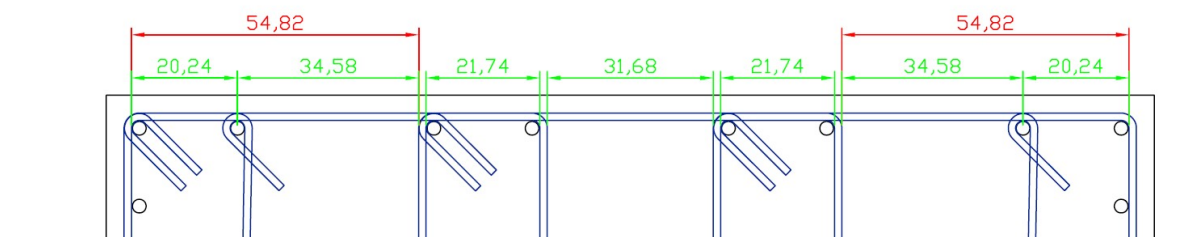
Distanze tra barre e spille - sezione trasversale (da +2,5m a +7,6 m)
